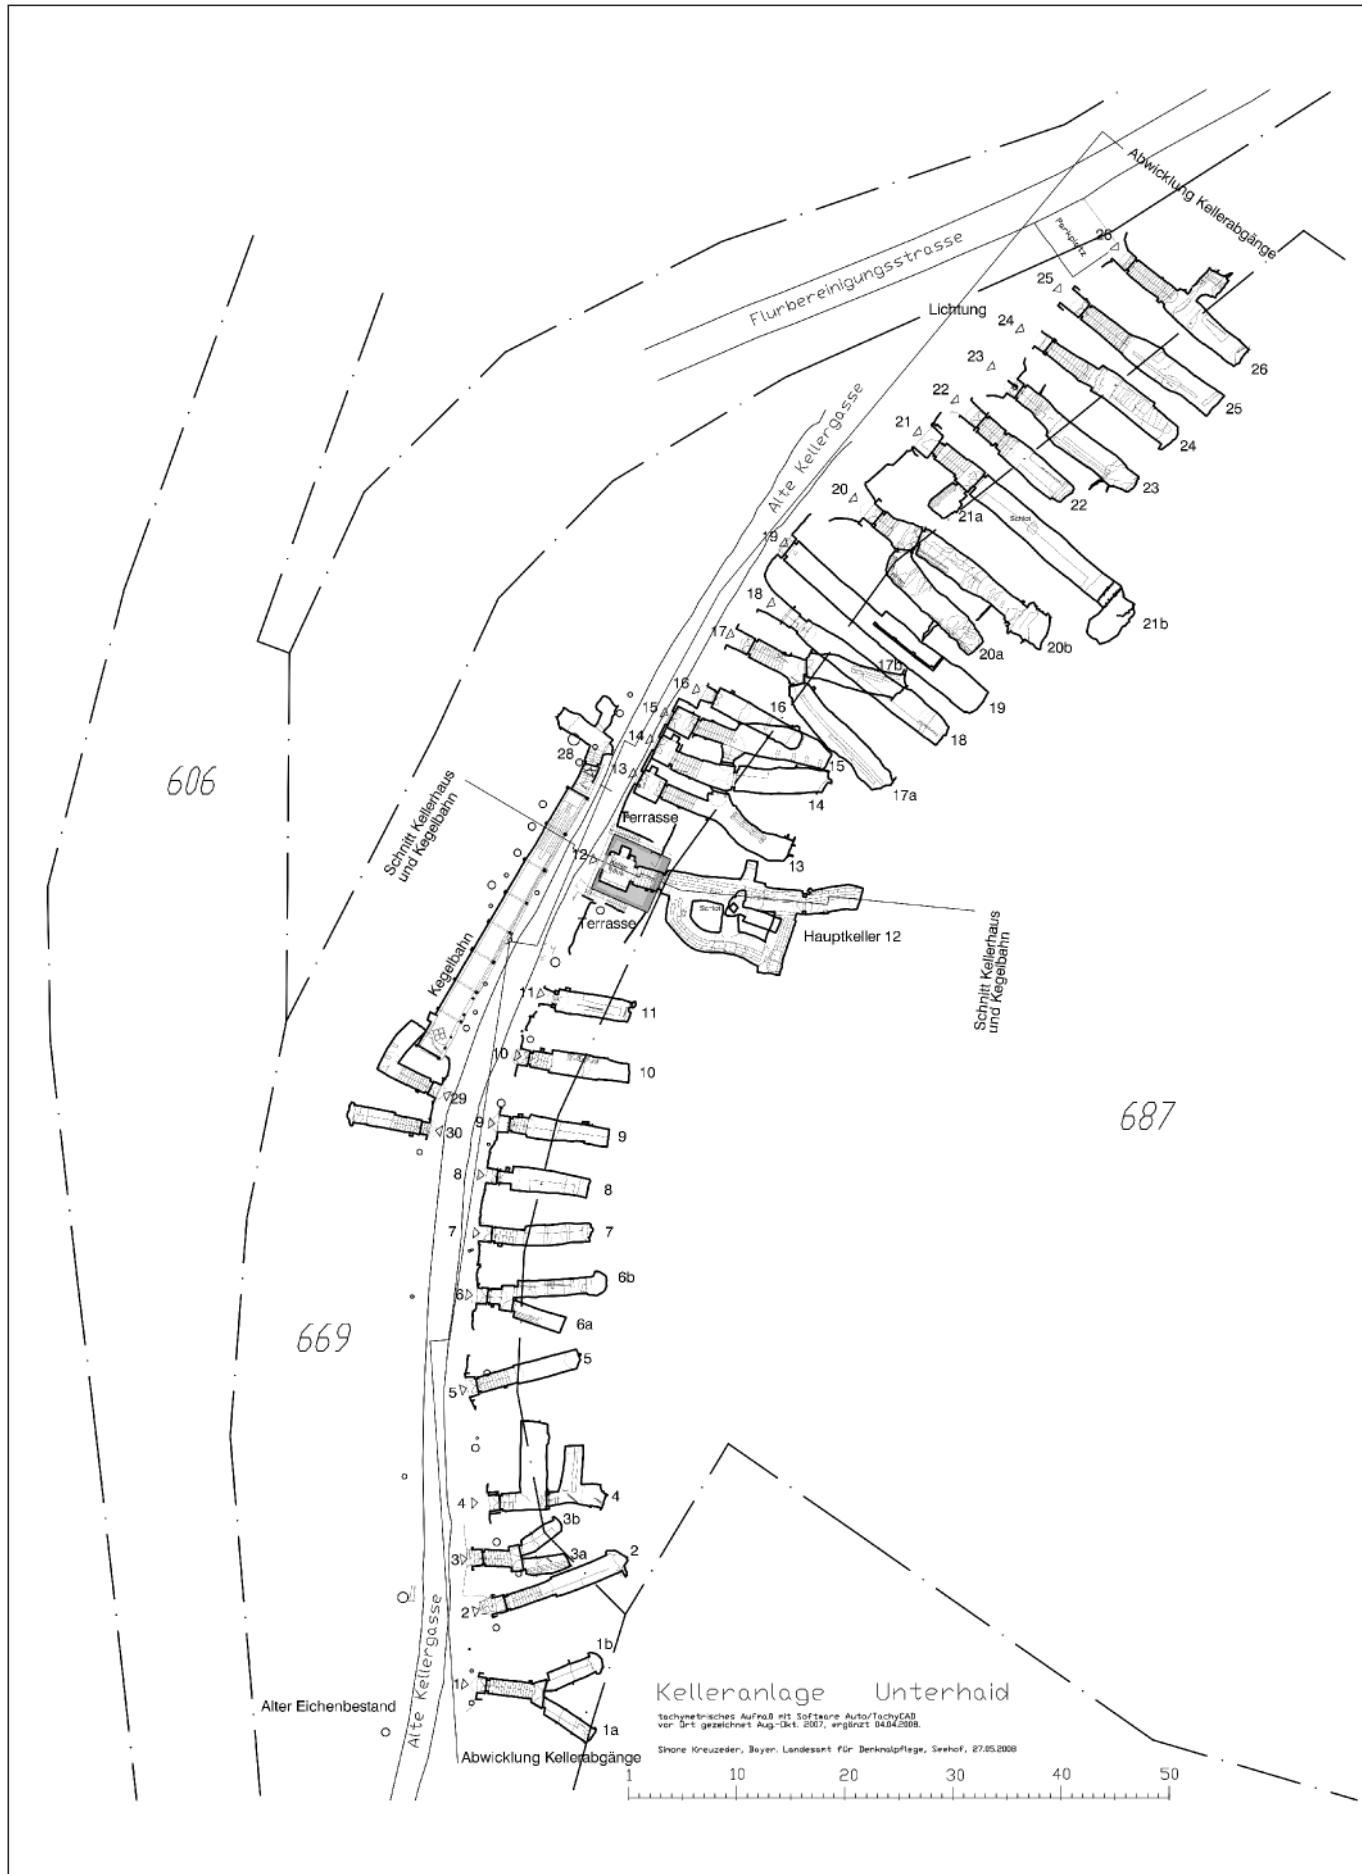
Grundriss der Kellergasse Unterhaid.
